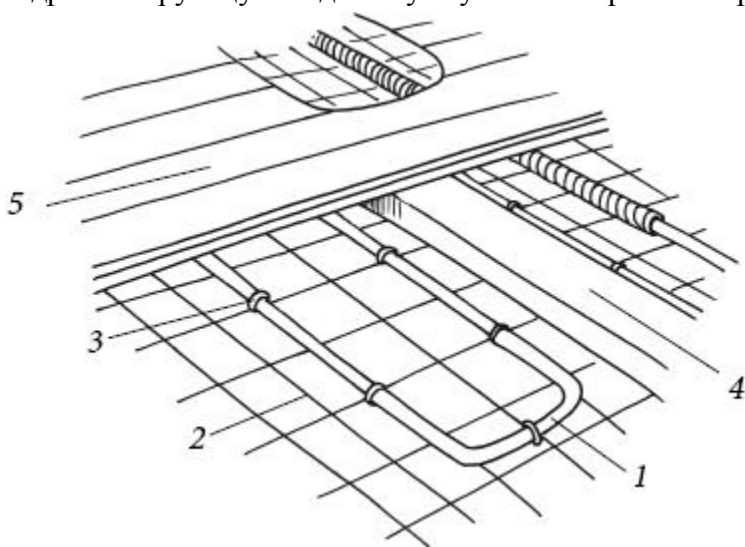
Деревянная настильная система монтажа водяного теплого пола: 1) трубы; 2) армирующая сетка; 3) хомуты; 4) деревянные опоры (лаги) для настила, не доходящие до края стен или с выемками для прохождения труб; 5) деревянный настил
